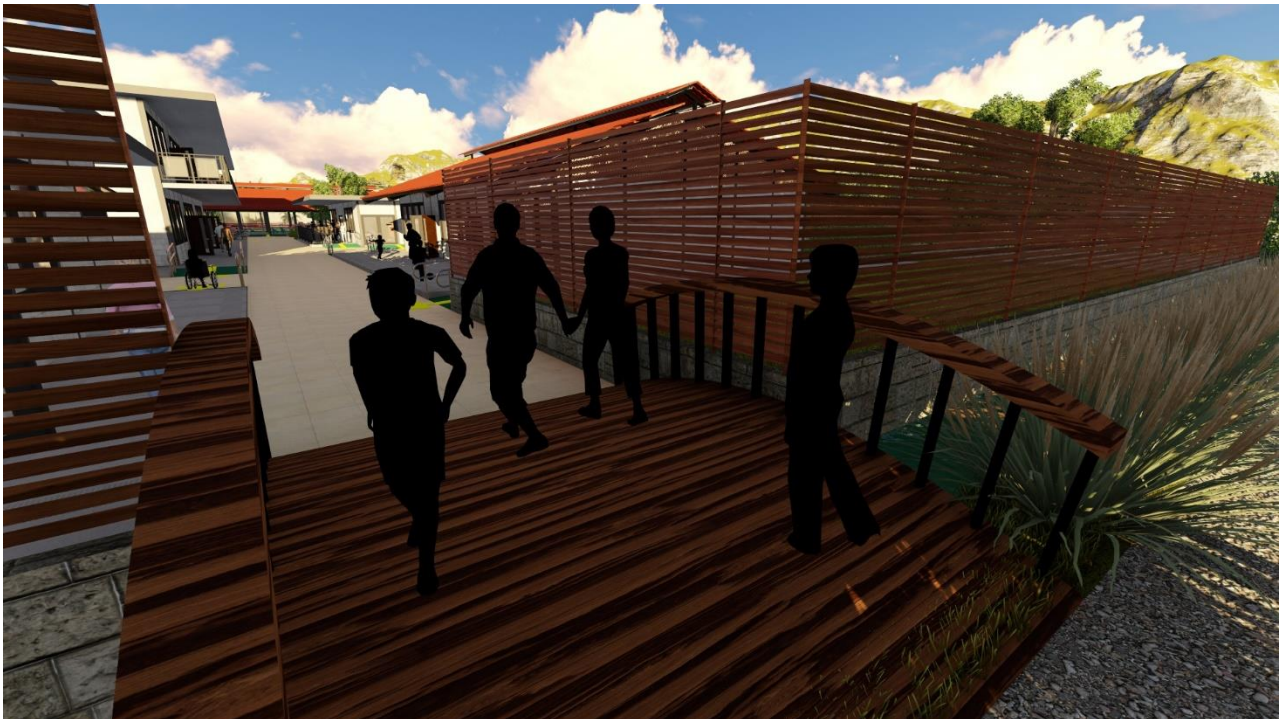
Apunte Fachada Ingreso Peatonal 2
